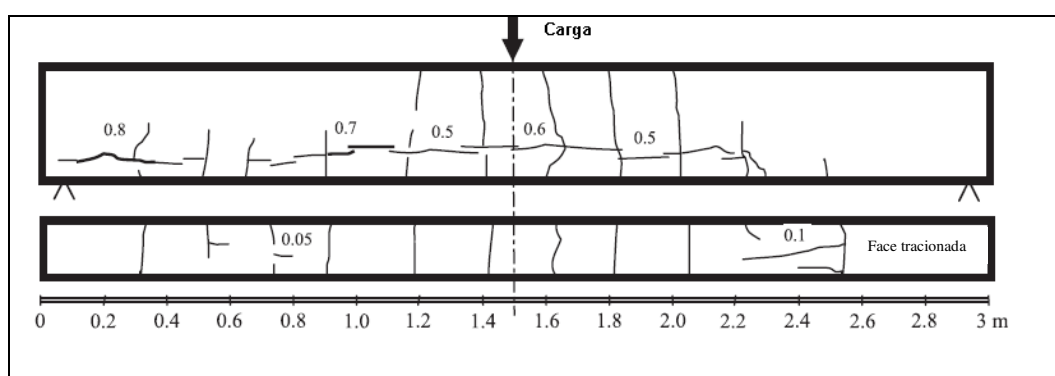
Mapeamento das fissuras das vigas (cobrimento de 40 mm) (VIDAL et al, 2004).
